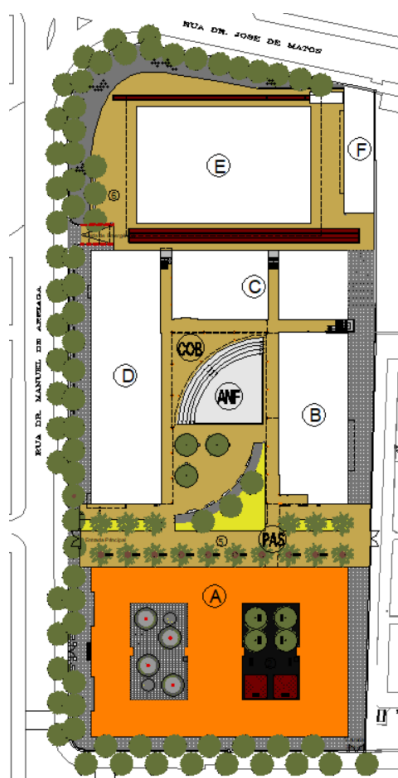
Planta da escola secundária e profissional com identificação dos blocos
